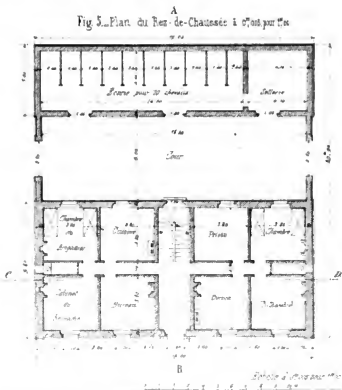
Plan du Rez-de-Chaussée à l'entrée
